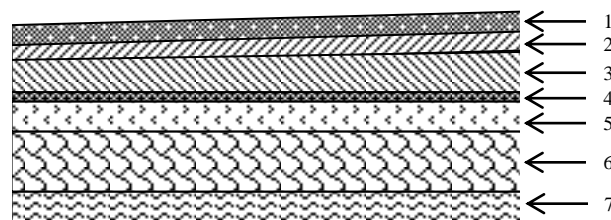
Coupe transversale du plancher terrasse inaccessible
